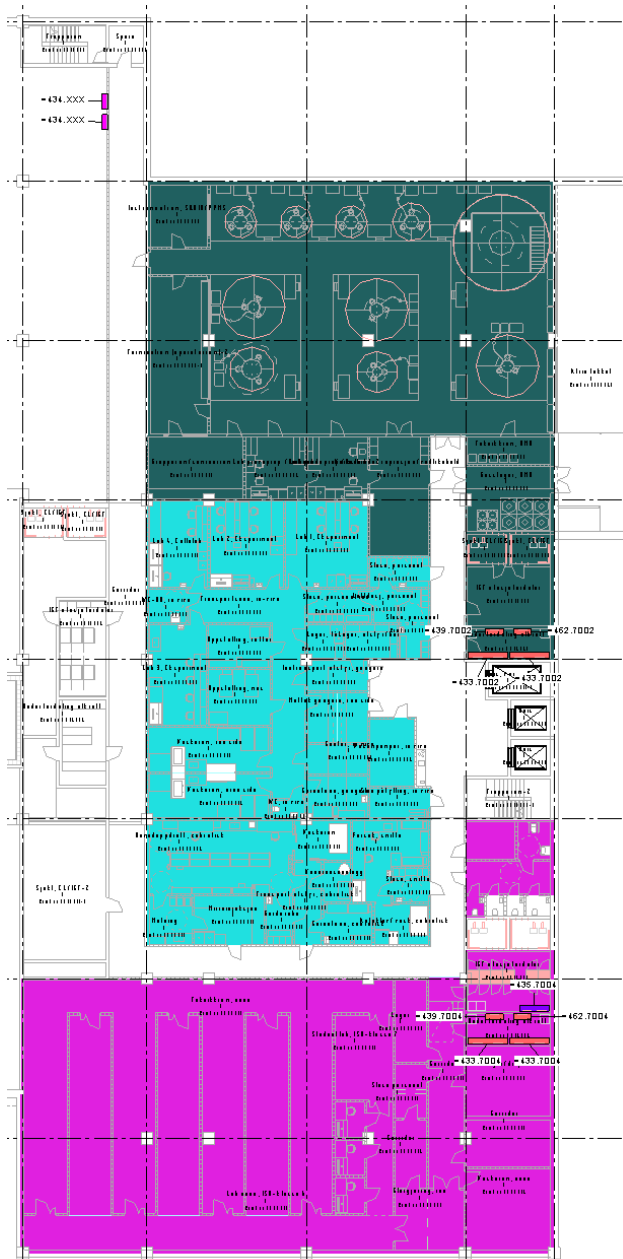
Horisontale føringer på plan 07, tilsvarende løsning på plan 06.
